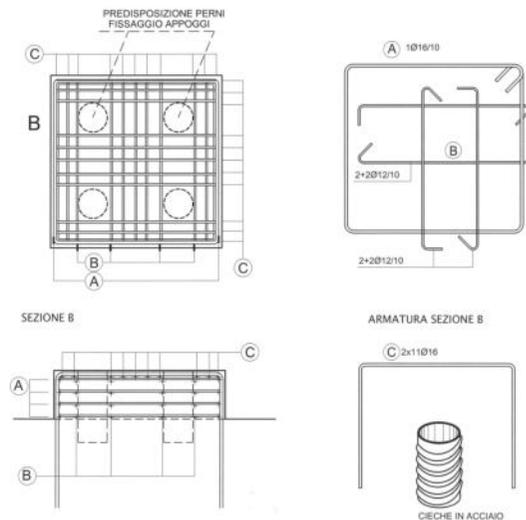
Armatura del baggiolo con ceche per l'alloggiamento delle zampe di collegamento degli appoggi
